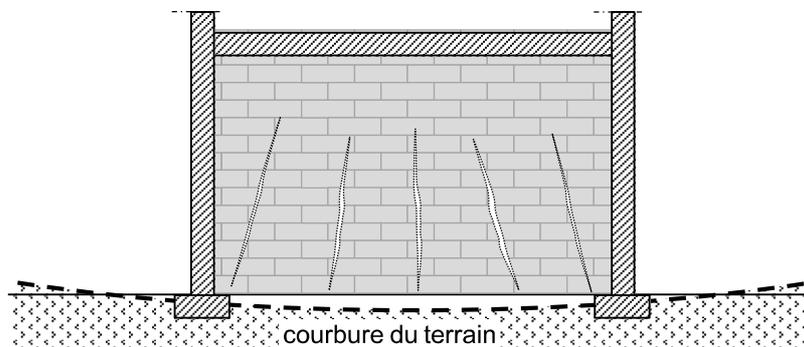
Exemple de fissures verticales et diagonales induites par la courbure du terrain
